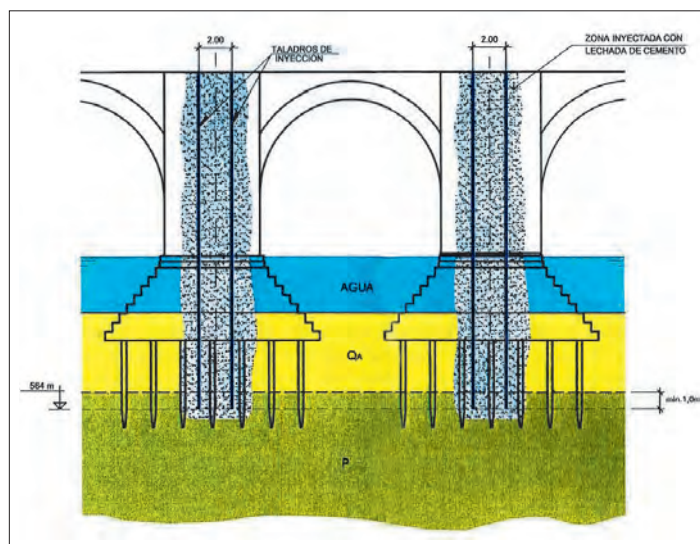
INYECCIONES DE REFUERZO DE LA FÁBRICA Y DEL TERRENO ALUVIAL BAJO LAS PILAS DEL PUENTE DE TOLEDO (MADRID), PREVIAS AL RECORTE PARCIAL DE LA CIMENTACIÓN.
